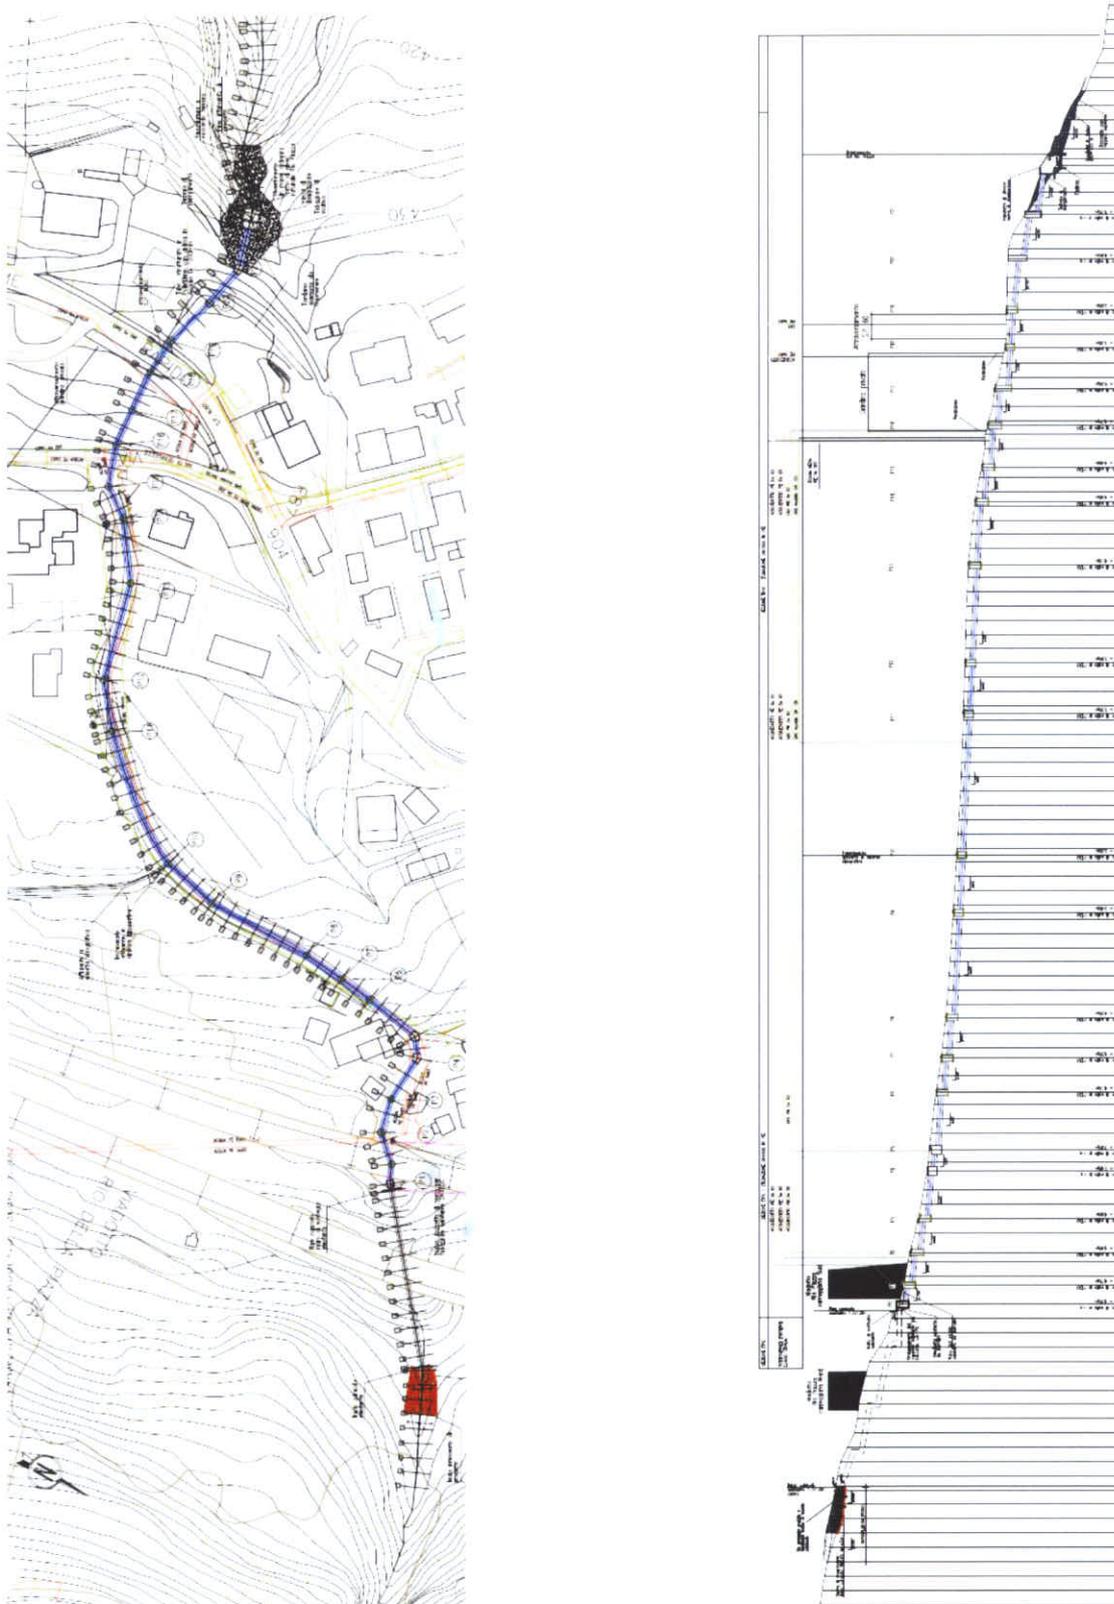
Progetto sistemazione Rio Piazza, planimetria e profilo.
